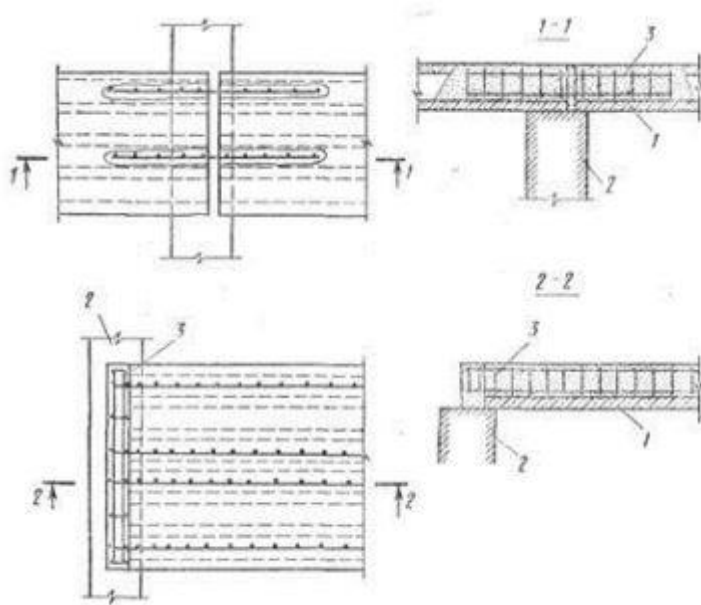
Усиление опорных частей многопустотных плит: 1 — усиливаемая плита; 2 — опора; 3 — арматурный каркас усиления
